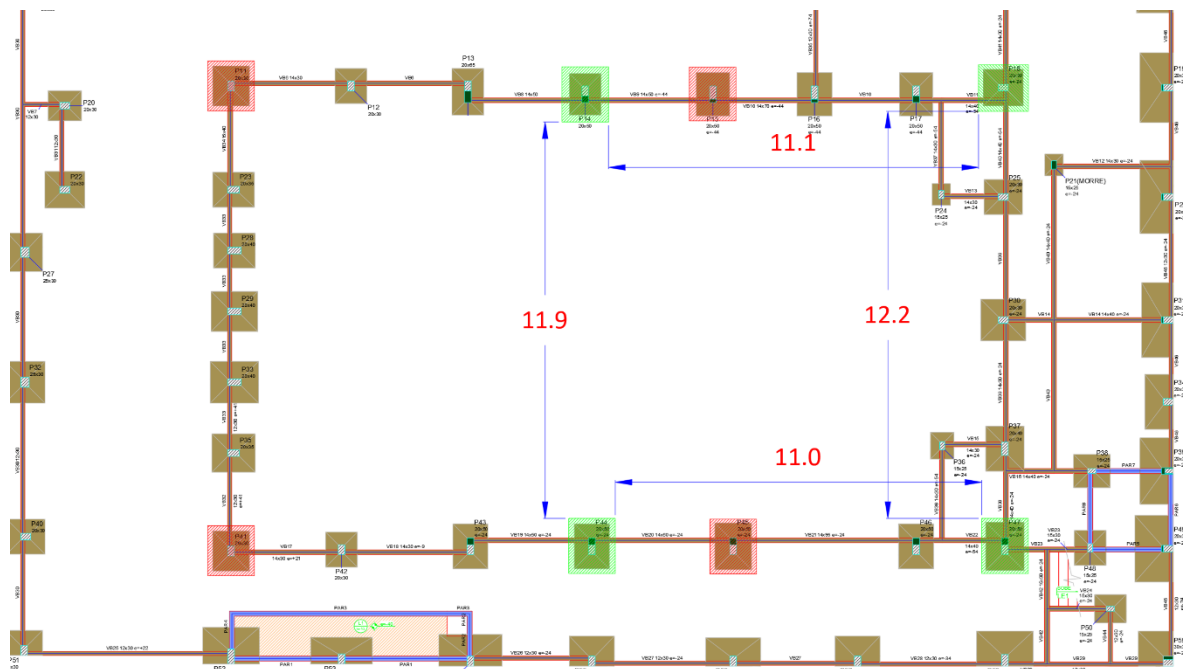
Demonstração das etapas posteriores do Plano de Execução das Fundações
